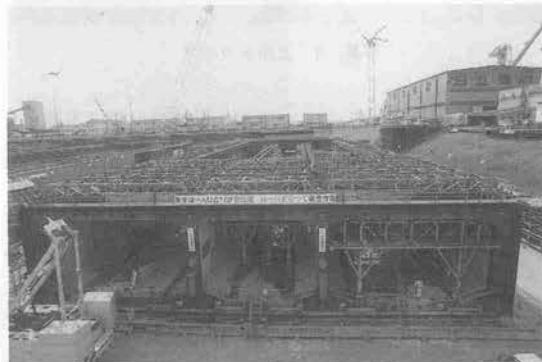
上床鉄筋トラベラおよび鉄筋つりトラス
